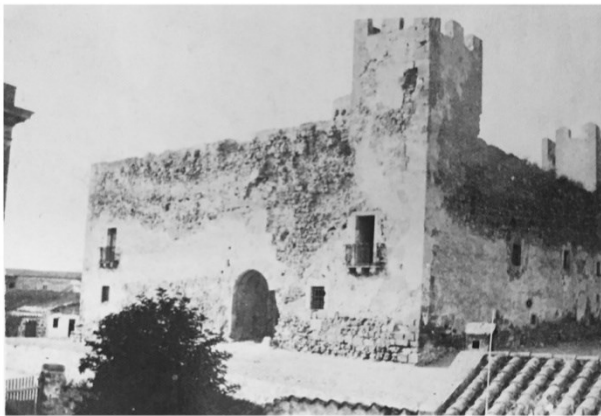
Progetto restauro Ing. Piras (1925)
